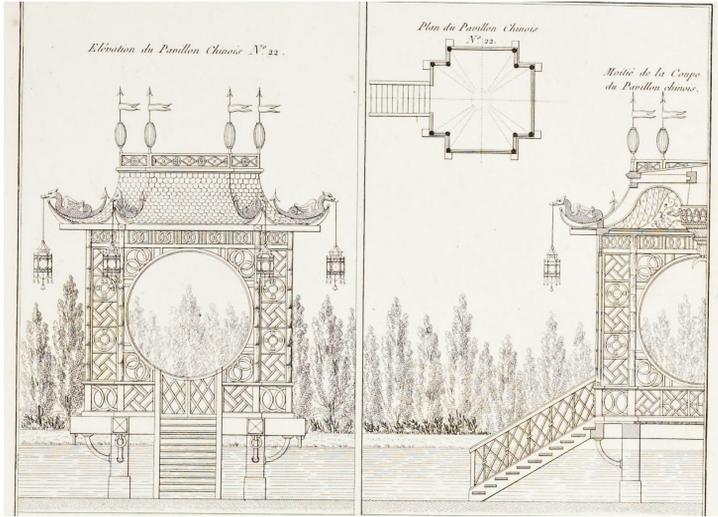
Krafft. Élévation, plan et moitié de la coupe du Pavillon chinois, jardin Saint-James, in: Recueil d'architecture civile, pl. III
